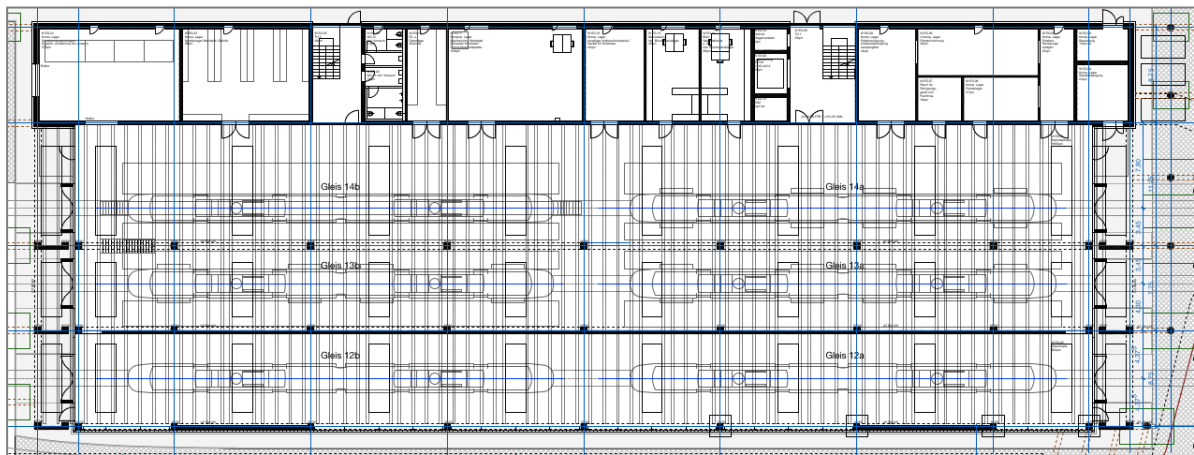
Grundriss Wasch-/Wartungshalle
